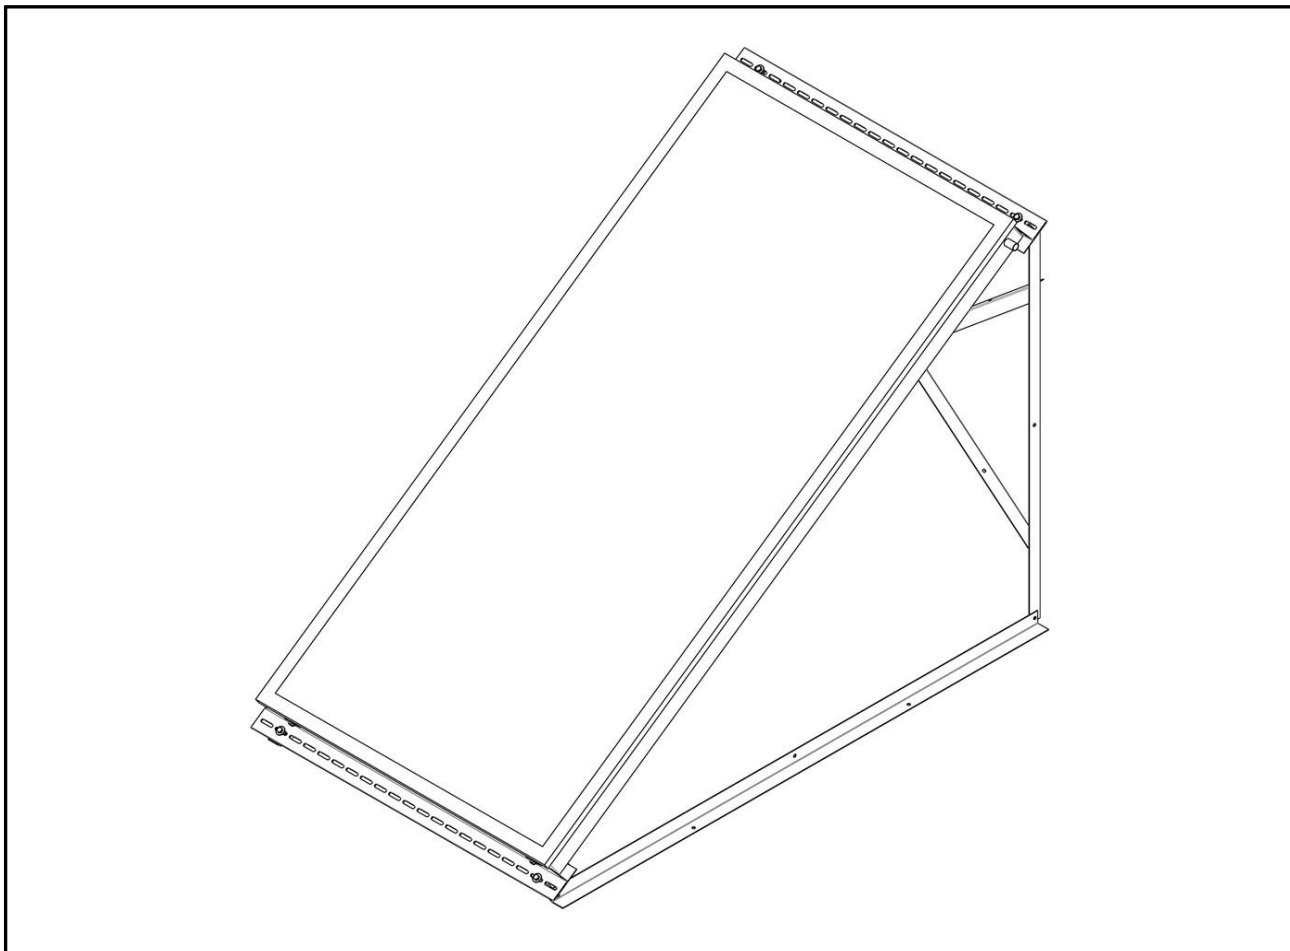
Installazione su tetto piano con inclinazione di 35°
